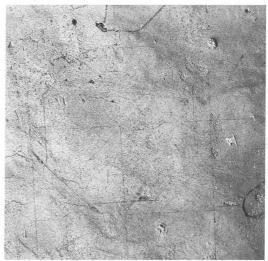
Traza del esquema de planta de un (foto del autor 2013)
